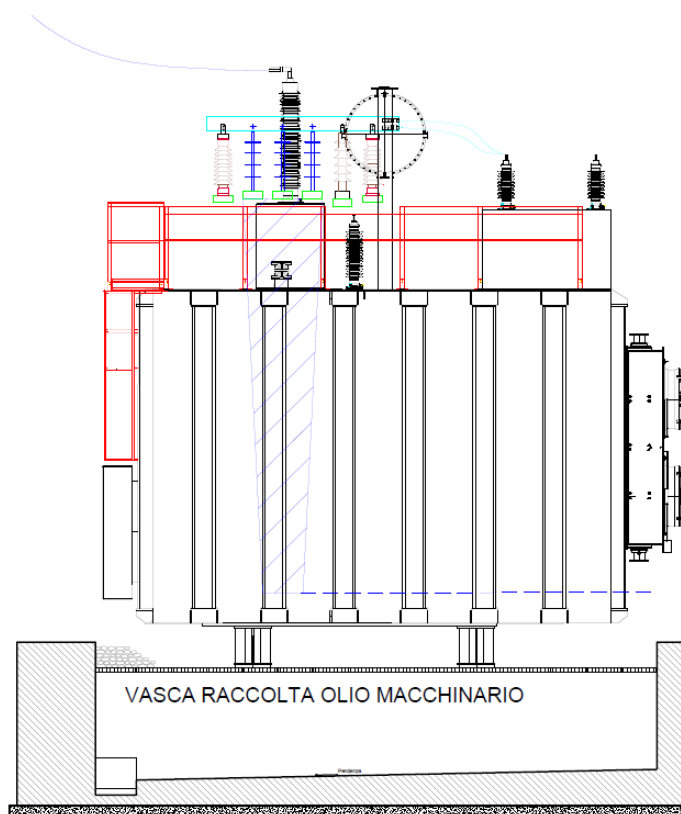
Rappresentazione schematica del sistema Vasca-Fondazione
